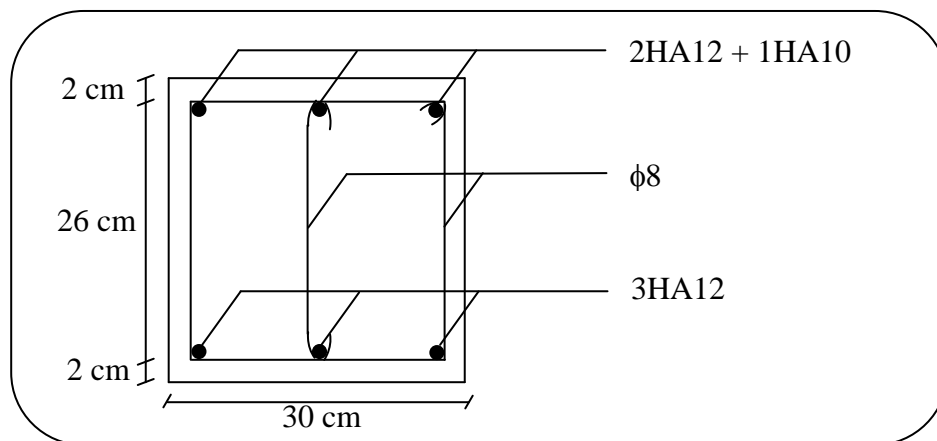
Schéma de ferrailage de la poutre brisée
